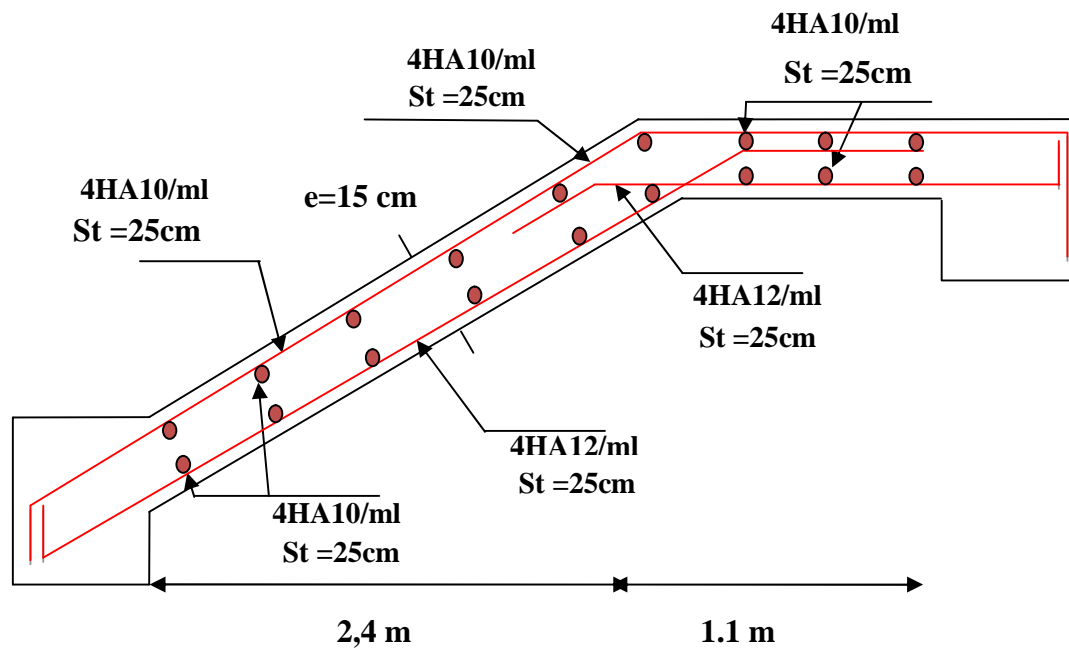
Schéma de ferrailage de l'escalier type 1
